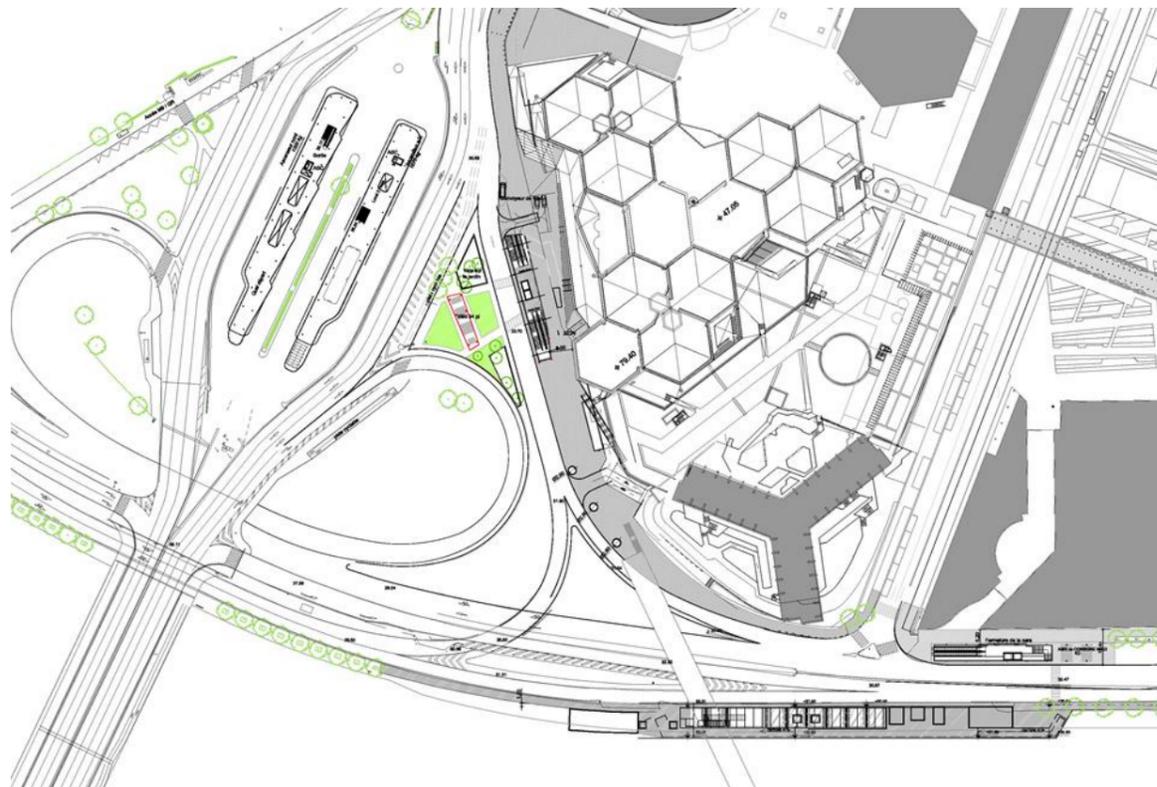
Gare de Pont de Sèvres – plan d'implantation du projet
